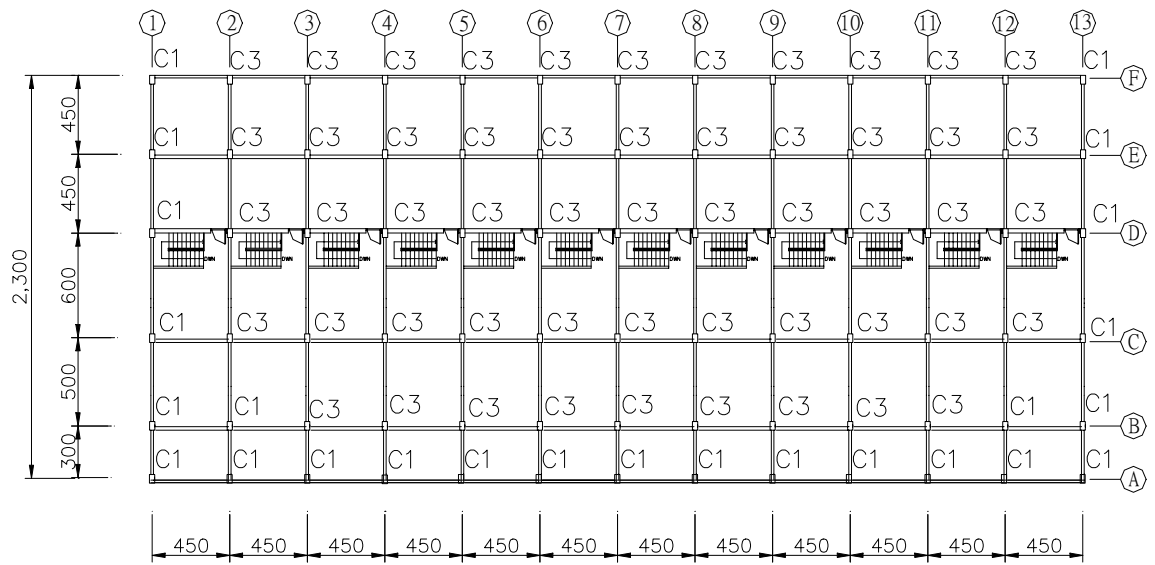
計算例之一樓結構平面圖與柱配筋圖
